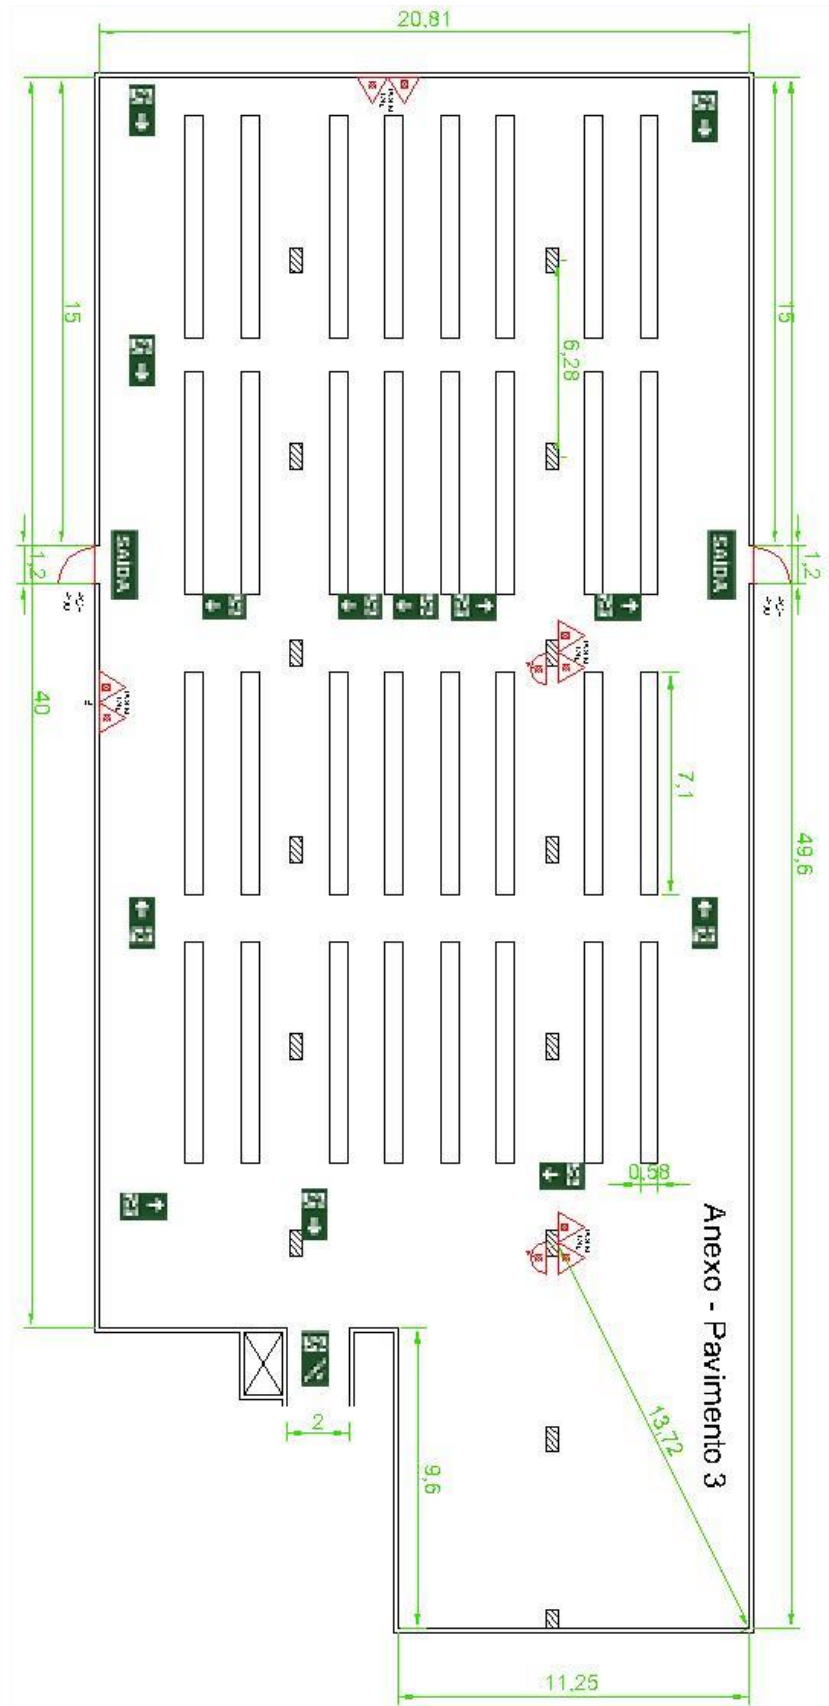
Plano de saída de emergência e sinalização no pavimento 3
